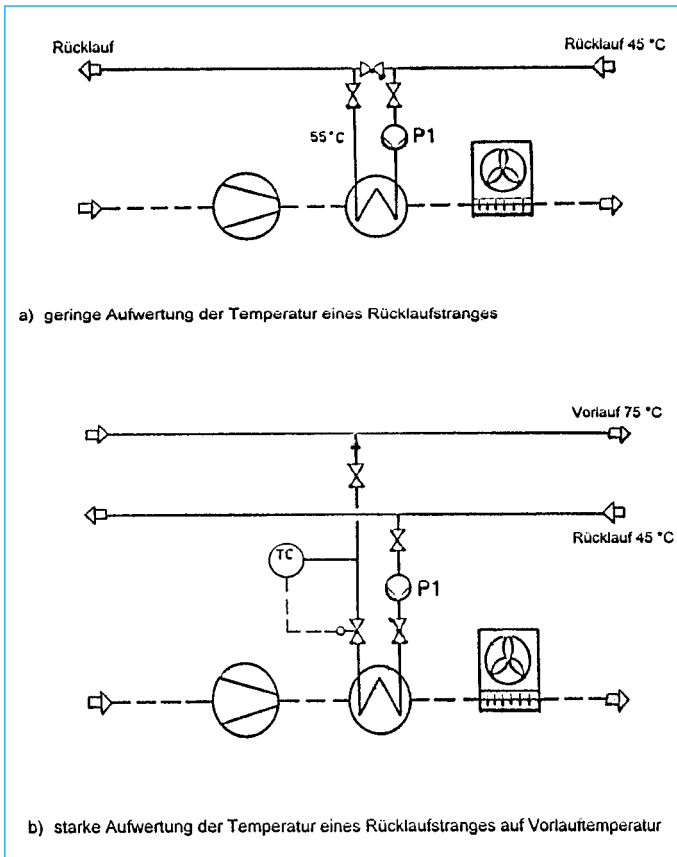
Anschluß an Heizungssysteme für Nachrüstungen
